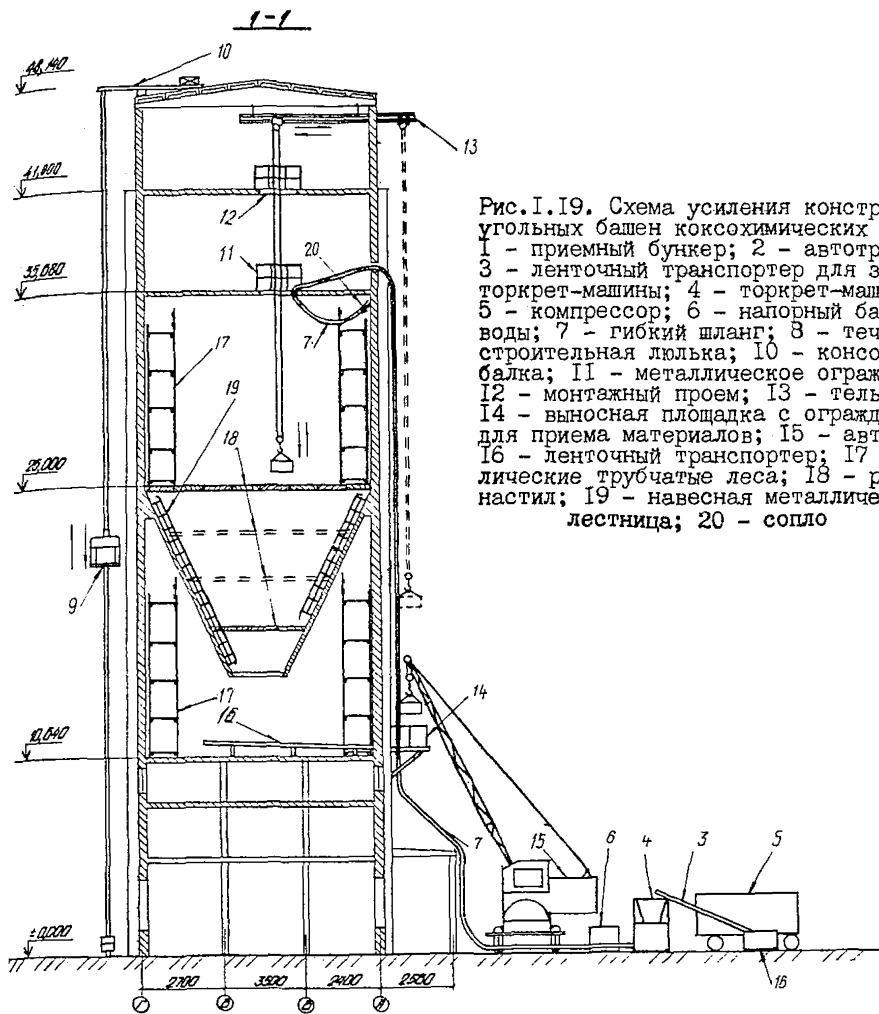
Схема усиления конструкций угольных башен коксохимических заводов: 1 - приемный бункер; 2 - автотранспорт; 3 - ленточный транспортер для загрузки торкрет-машины; 4 - торкрет-машина; 5 - компрессор; 6 - напорный бак для воды; 7 - гибкий шланг; 8 - течка; 9 - строительная люлька; 10 - консольная балка; 11 - металлическое ограждение; 12 - монтажный проем; 13 - тельфер; 14 - выносная площадка с ограждением для приема материалов; 15 - автокран; 16 - ленточный транспортер; 17 - металлические трубчатые леса; 18 - рабочий настил; 19 - навесная металлическая лестница; 20 - сопло
